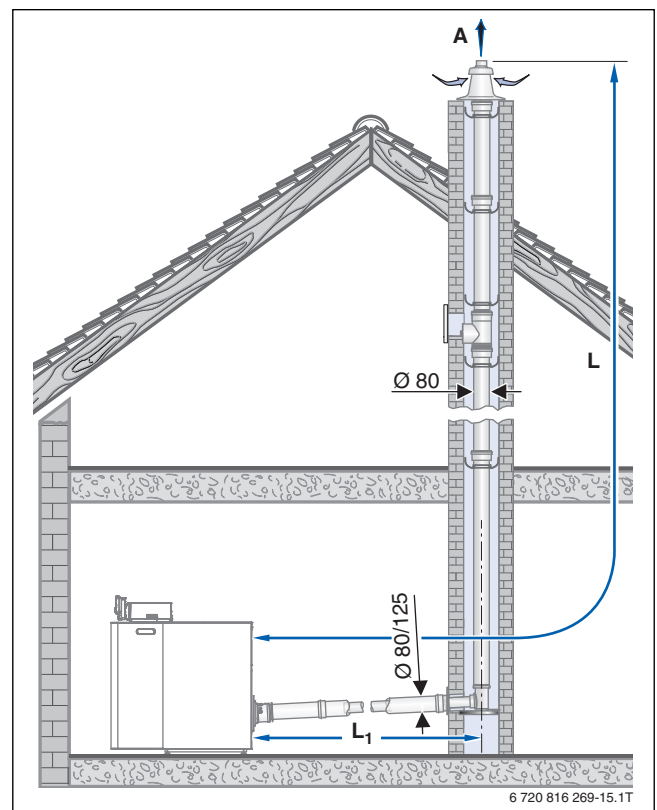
Conducción por tubo individual en la chimenea, rígido (C_{93(x)})
